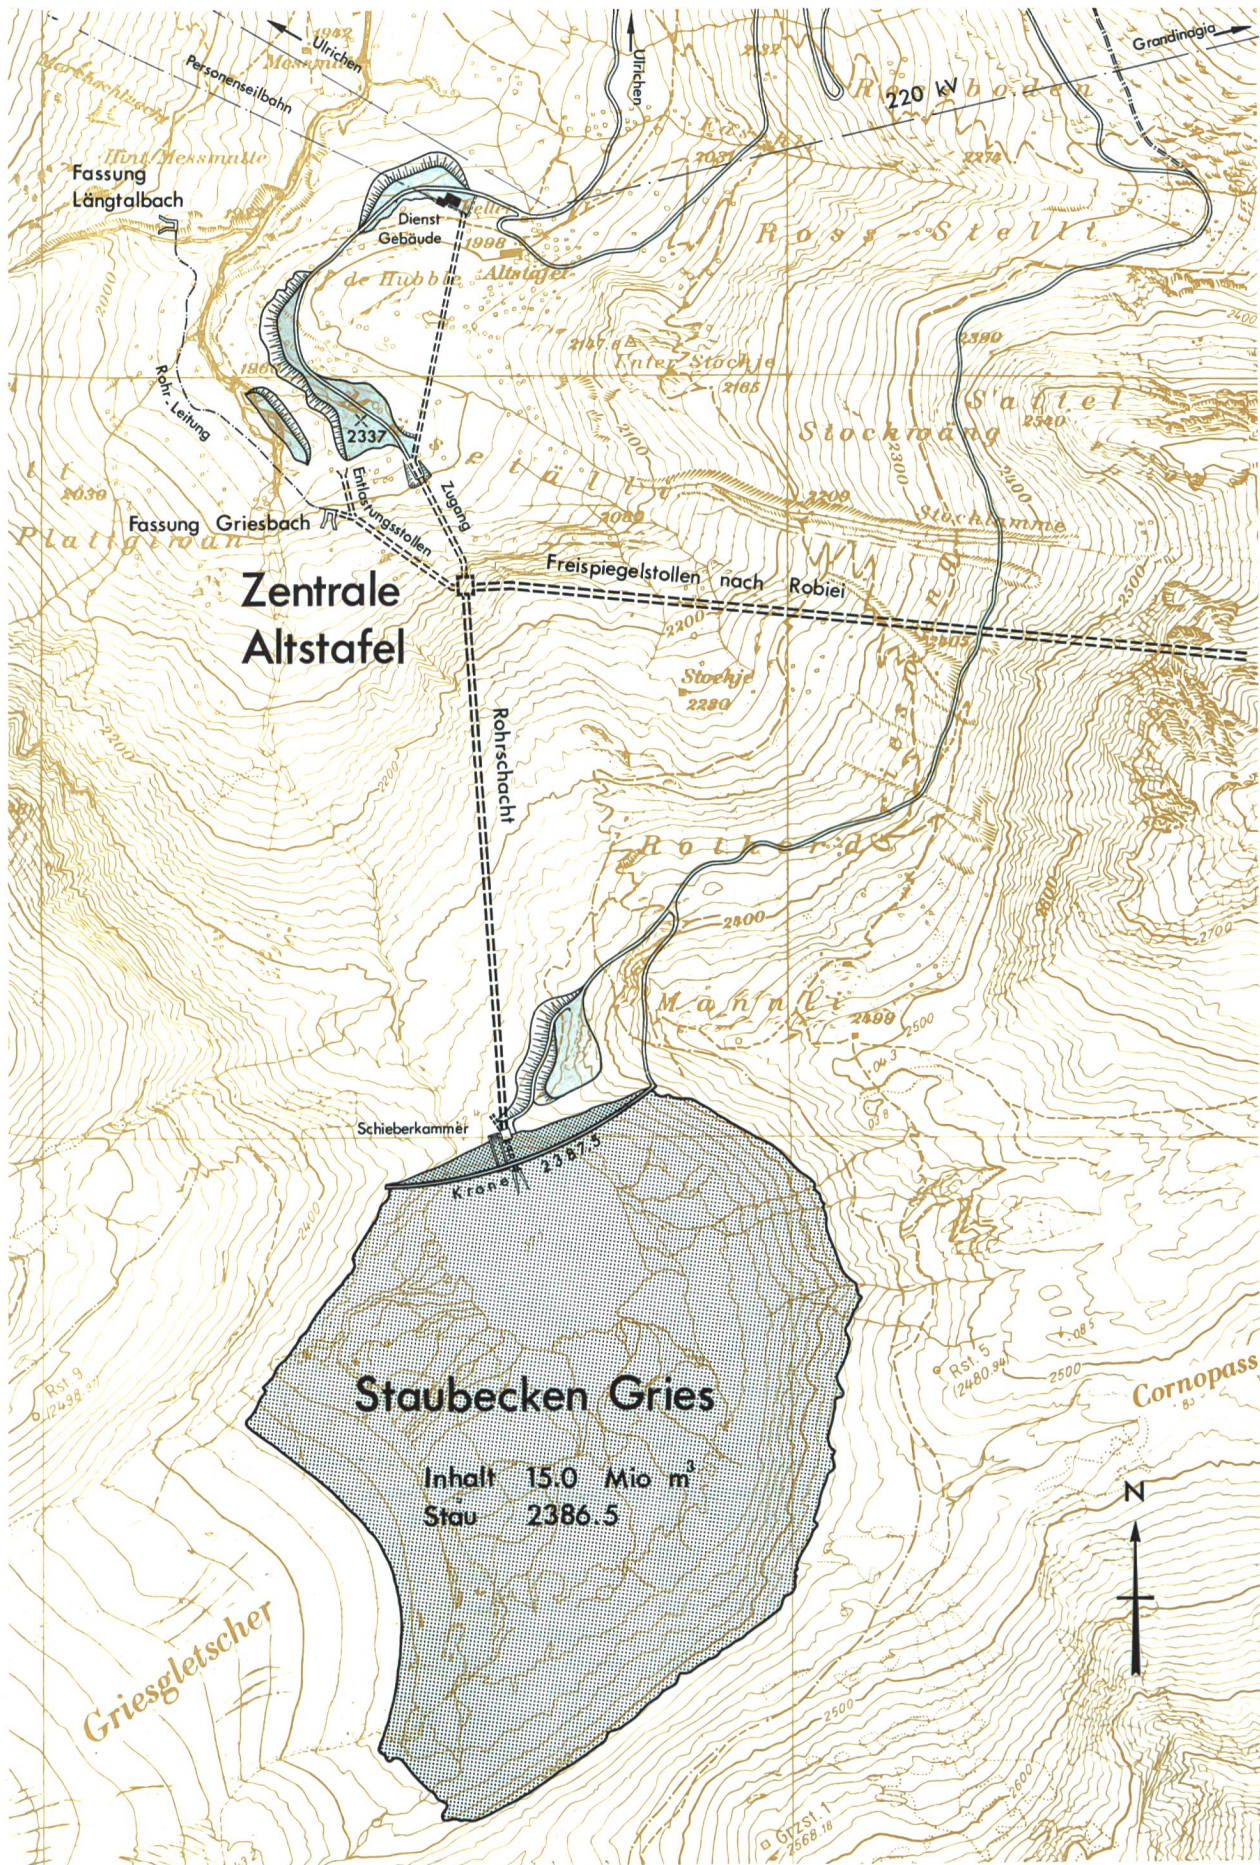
Staubecken Gries, Lageplan 1 : 10 000
